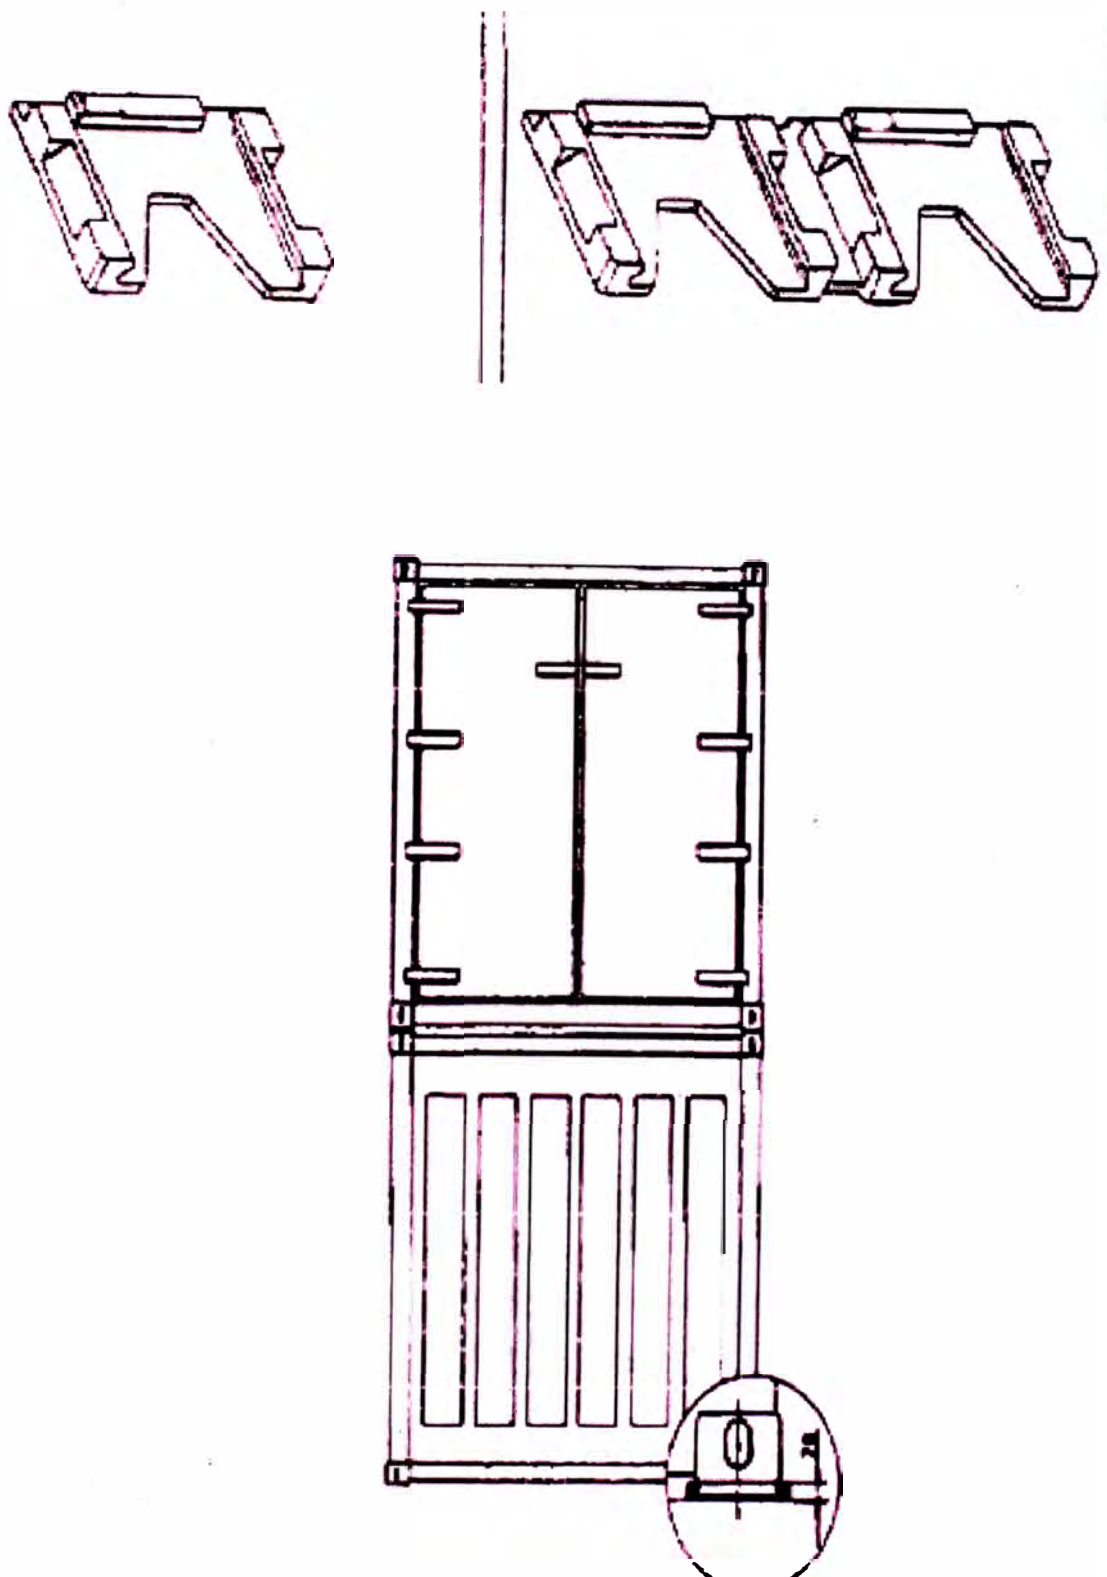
Dovetail foundations, fundamentos de cola
